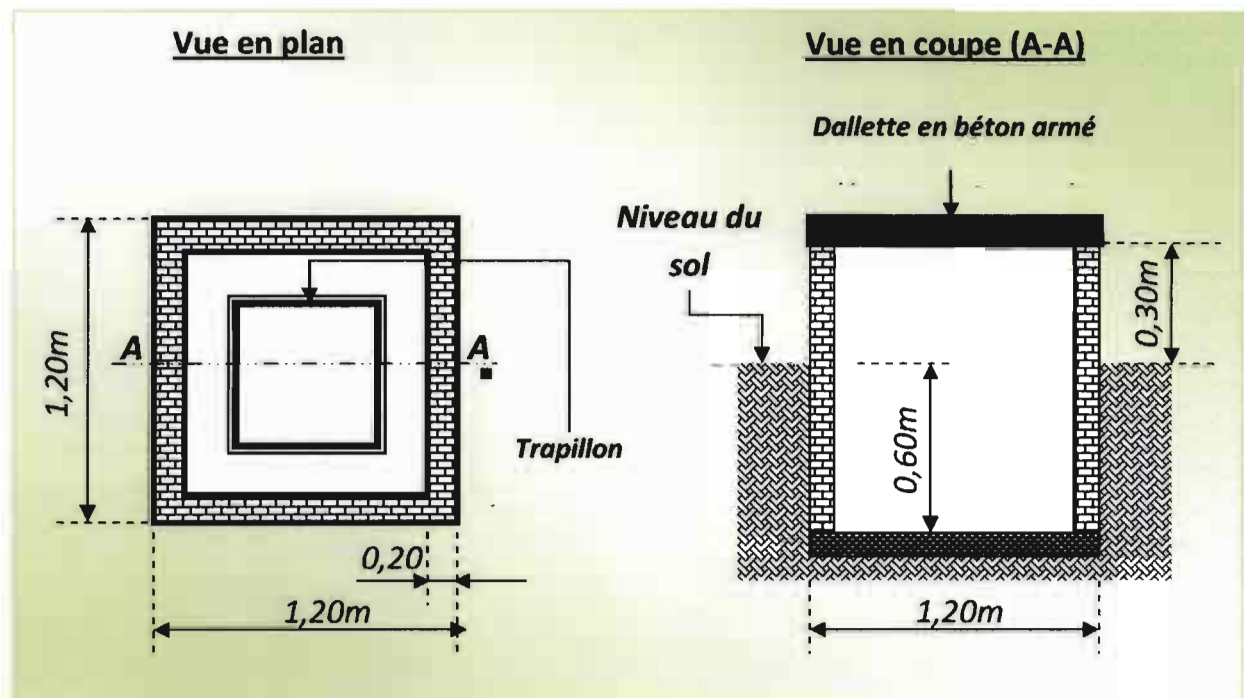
Plan d'une chambre de vanne de sectionnement
